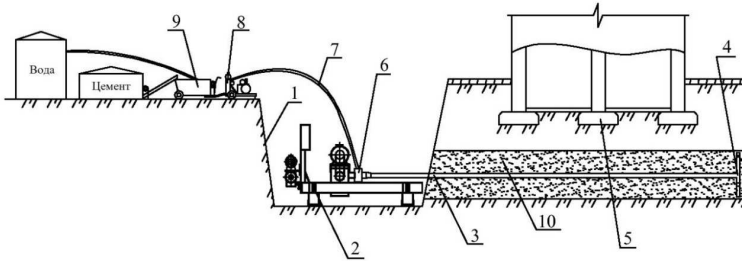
Технологическая схема горизонтального армирования грунтов:
